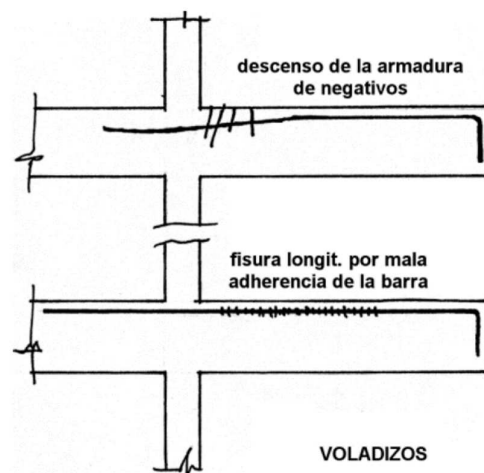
Reducción de canto útil en vigas de voladizo(Fuente, MPE)
